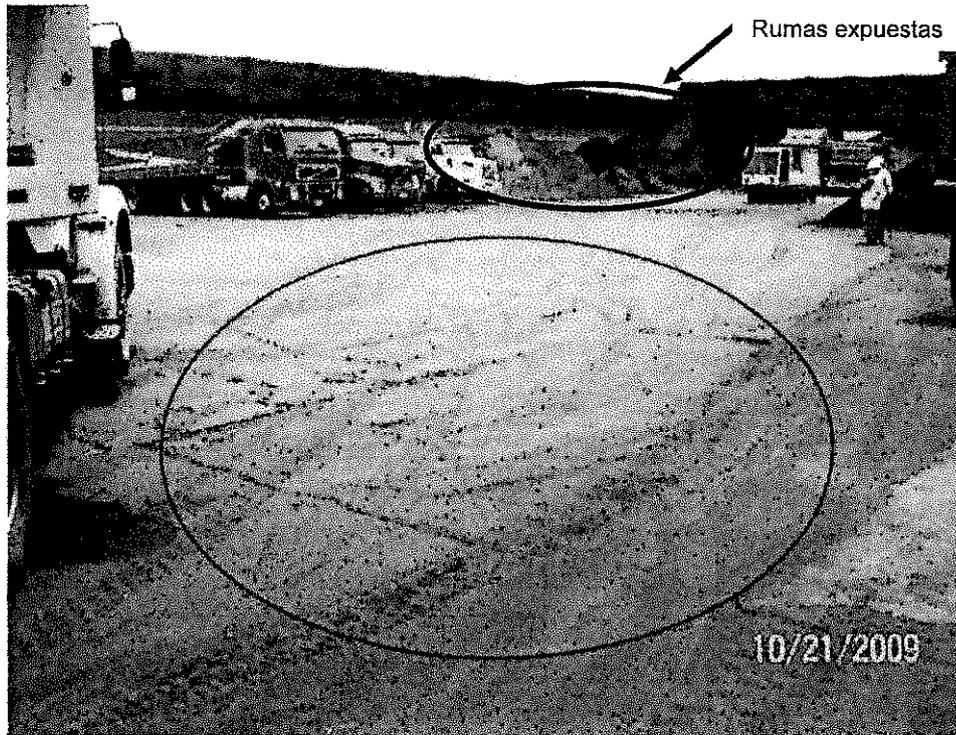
Losa de concreto de la parte central del depósito de concentrados (Patio 3). Nótese las fisuras y rajaduras del piso.
